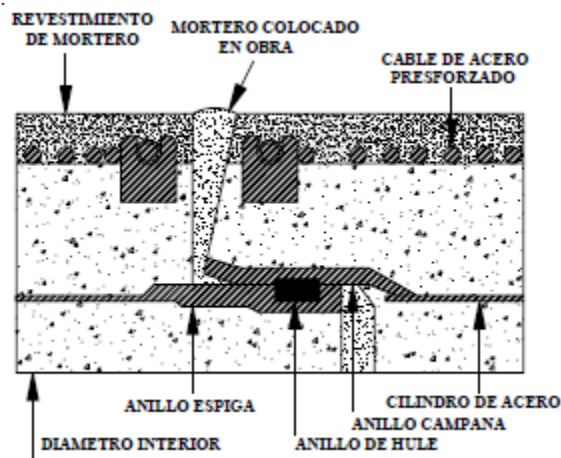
Unión espiga-campana en tuberías de concreto con cilindro de acero
